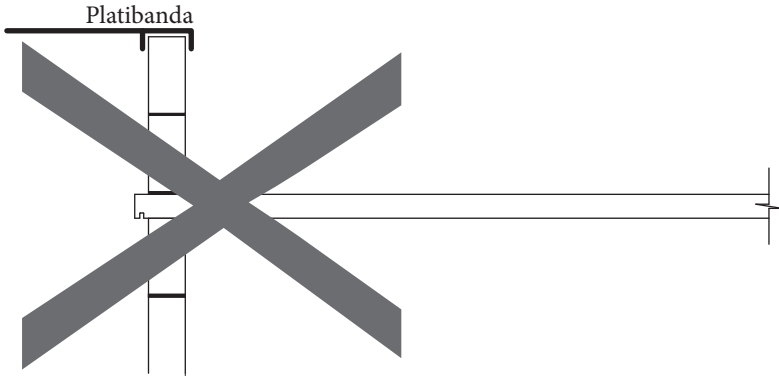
Balancim engastado em platibanda apenas em alvenaria não é permitido.
